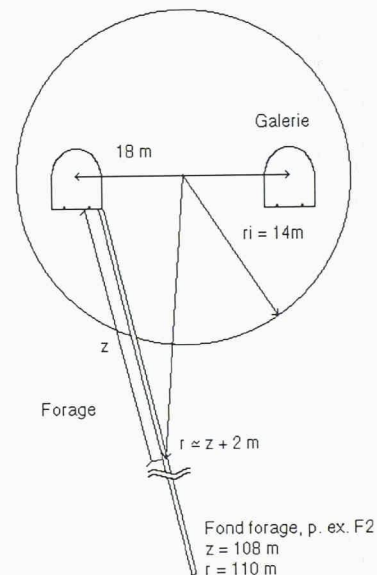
Coupe transversale du tunnel avec positionnement du forage
